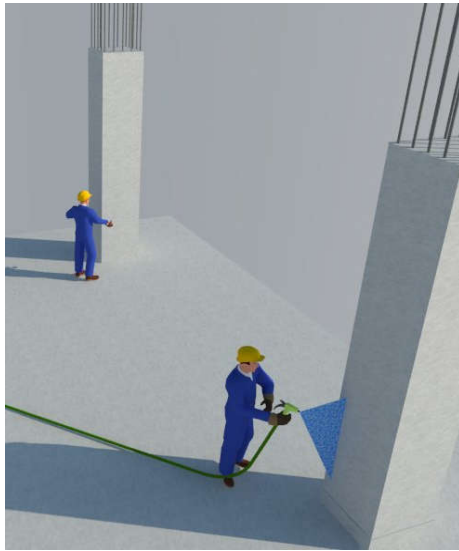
12 Bekisting Kolom yang telah dibongkar
